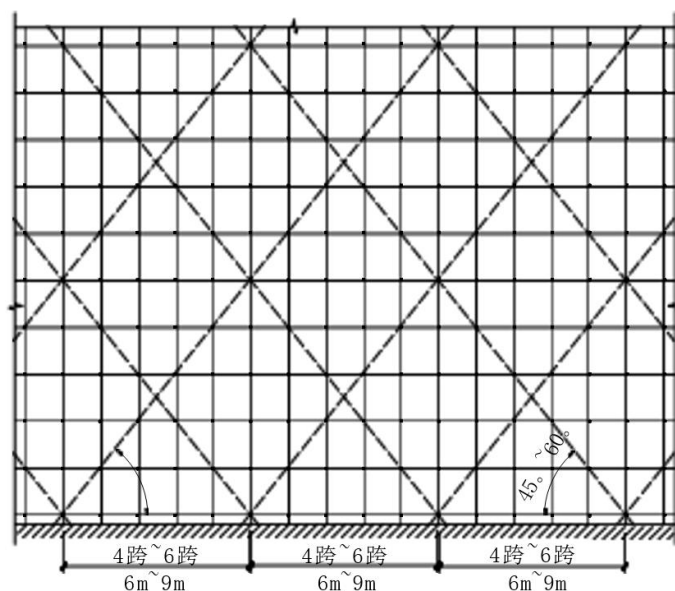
脚手架竖向、水平剪刀撑布置示意
